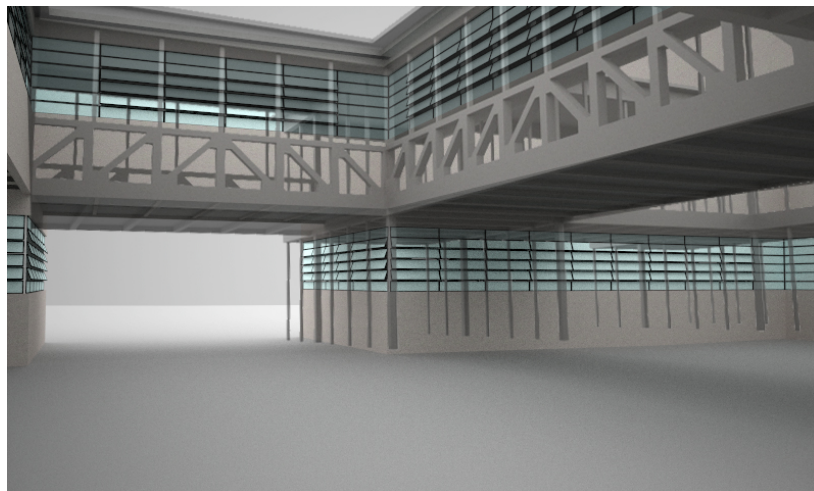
Montagem da estrutura e arquitetura. Fonte: Autor, 2014.
